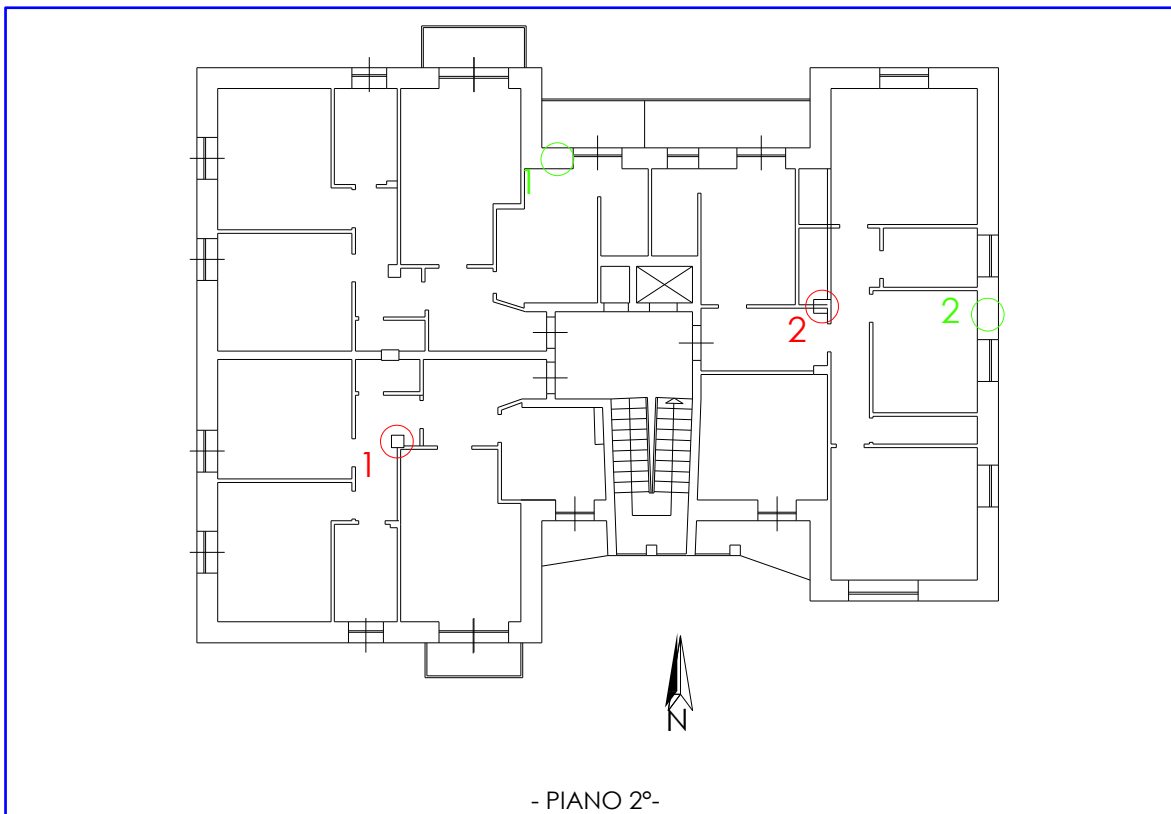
Planimetria del piano secondo (L2) con l'ubicazione delle zone esaminate
